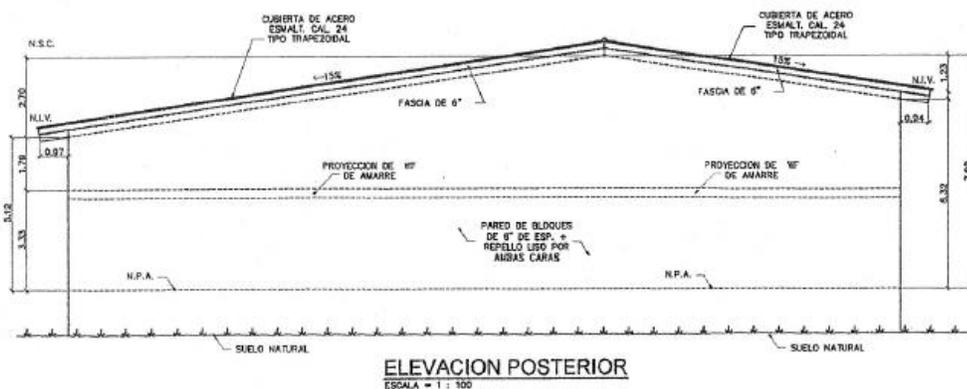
Vista elevación lateral de la Galera a Construir. Fuente: Planos del Proyecto.
